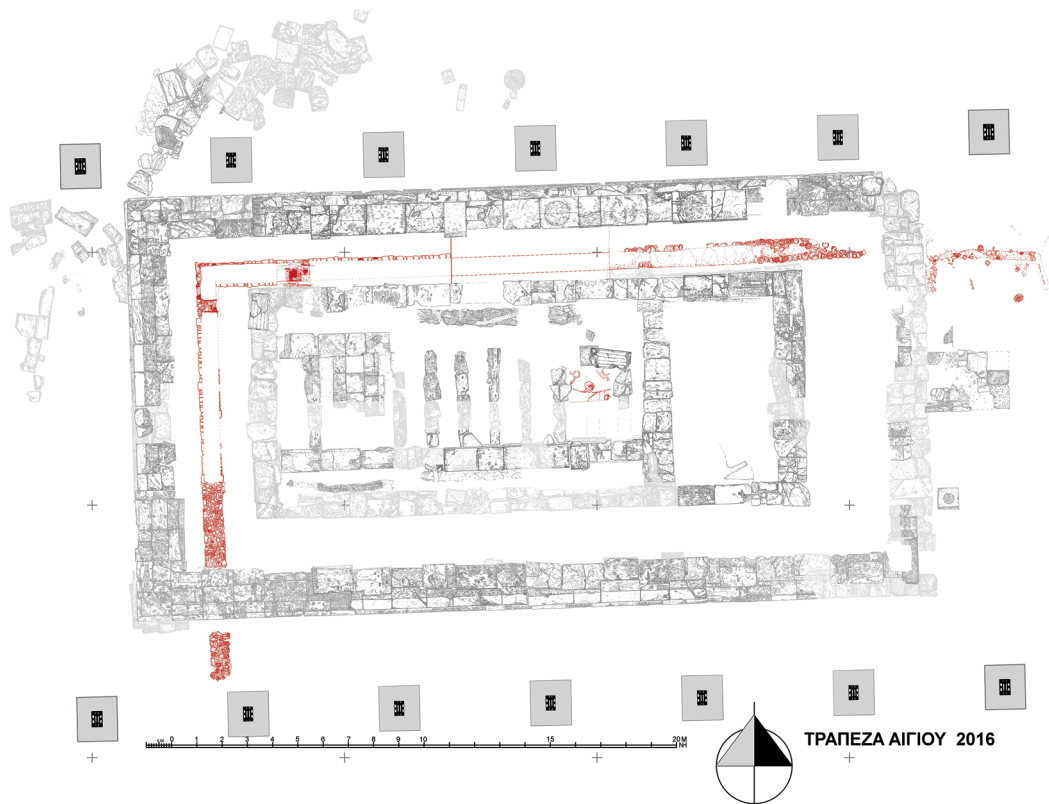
Trapezá Aigiou, Steinplan des Tempels mit geometrischem Vorgängerbau (rot) (M. 1 : 300)
